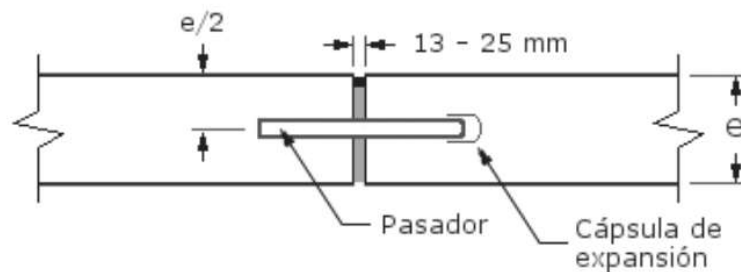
JUNTA TIPO E. JUNTA DE DILATACIÓN.
